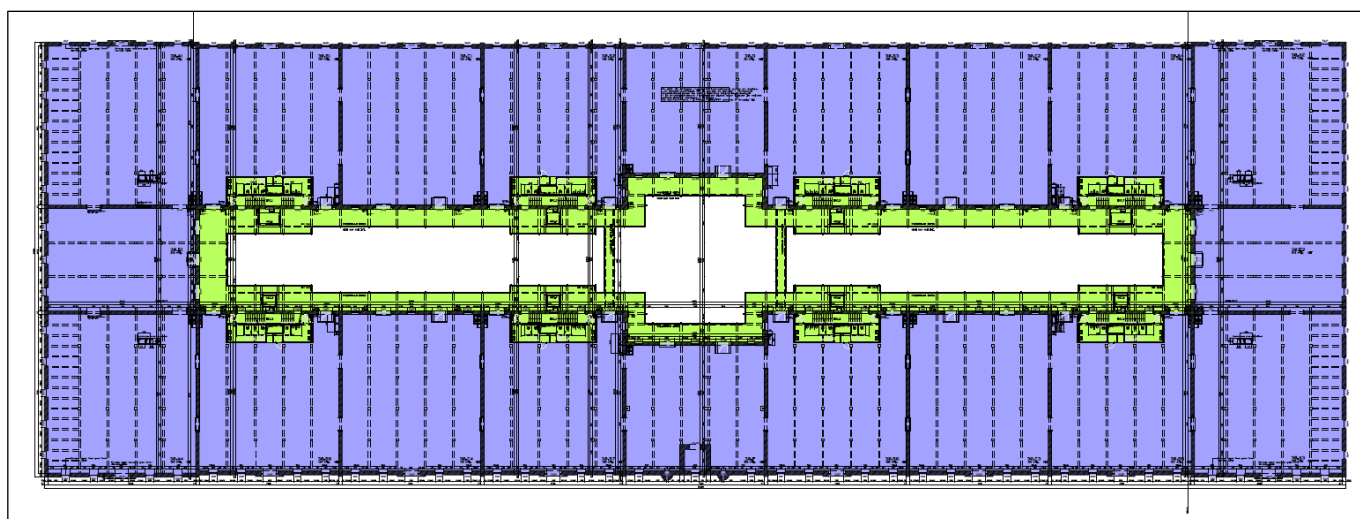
, Bâtiment B, situation existante de droit – 4<sup>ème</sup> étage
